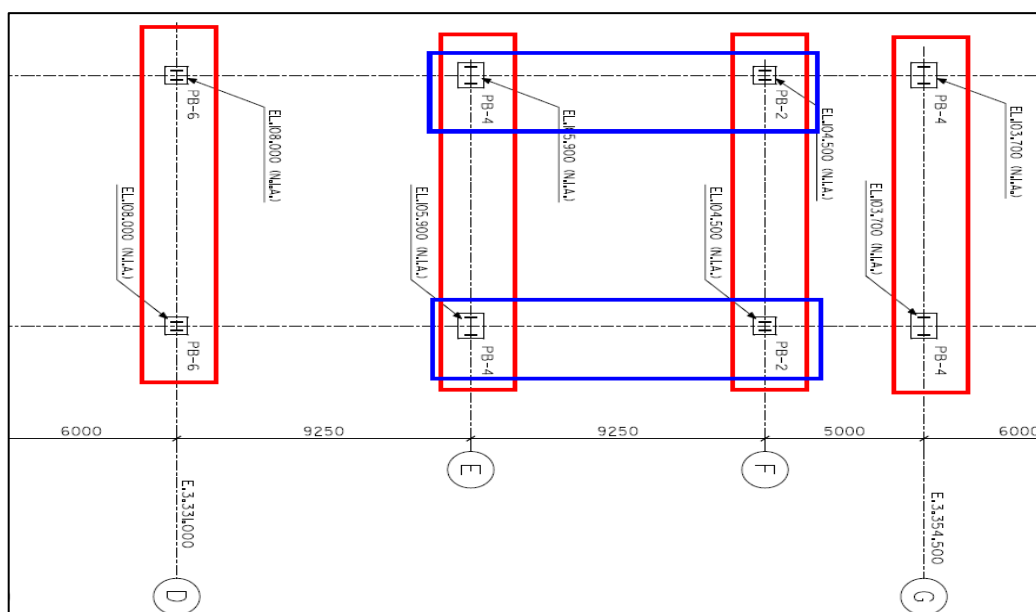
Vista de planta del rack BTCTG, ejes D al G
